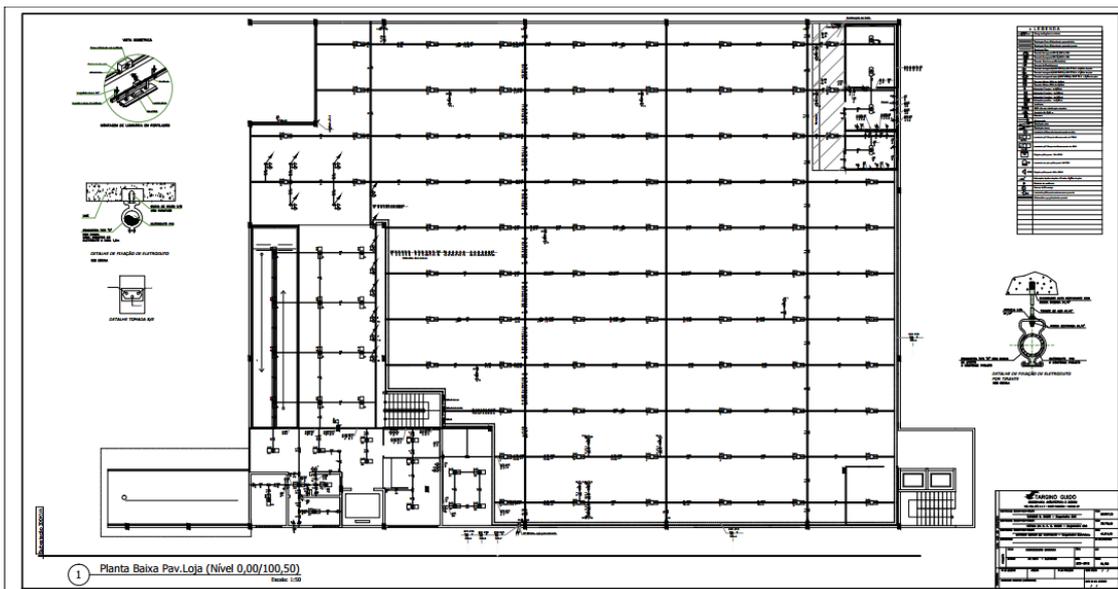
Planta baixa da iluminação pav. loja da filial Mariana – COOPEROURO.
